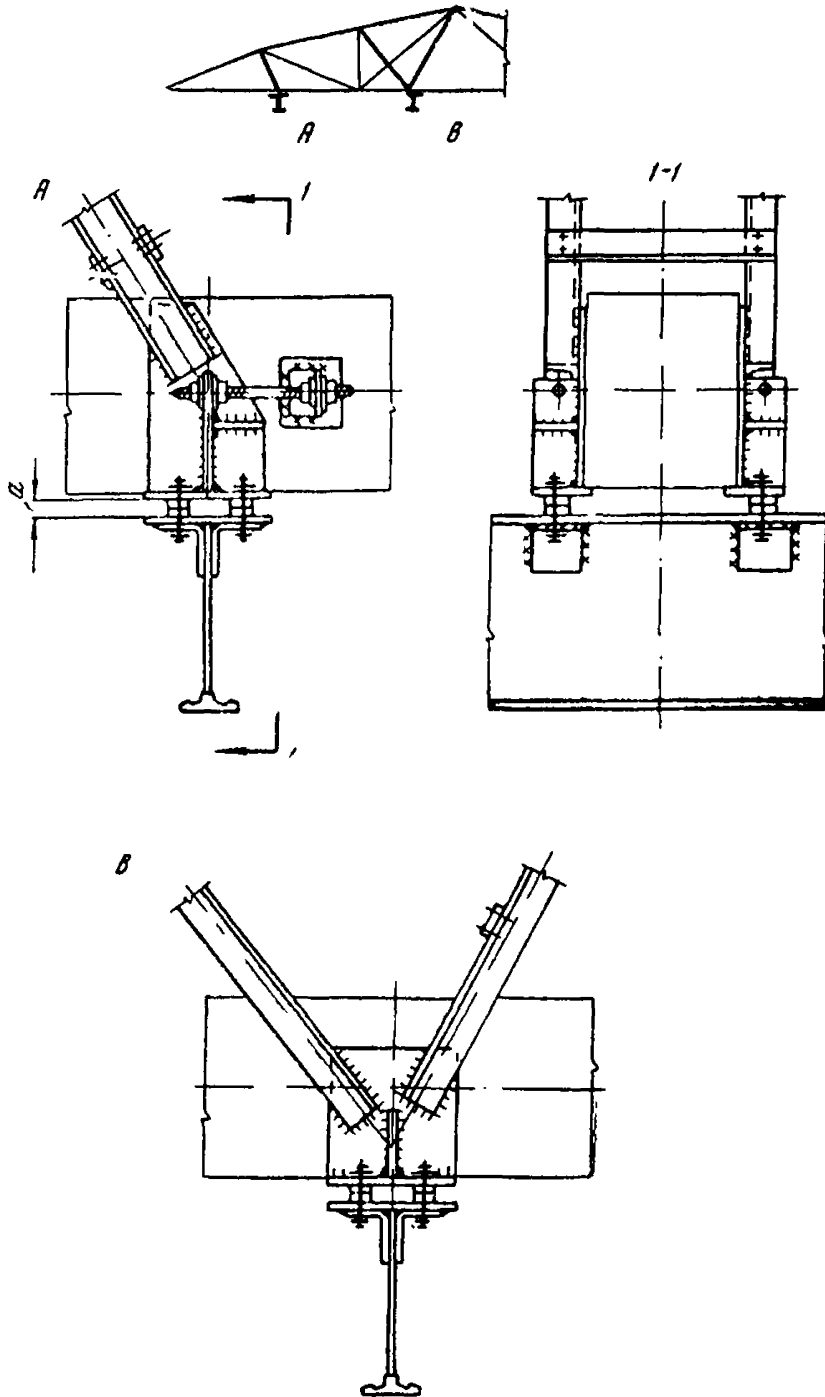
Подвеска балки в панели железобетонной фермы на закладных деталях
